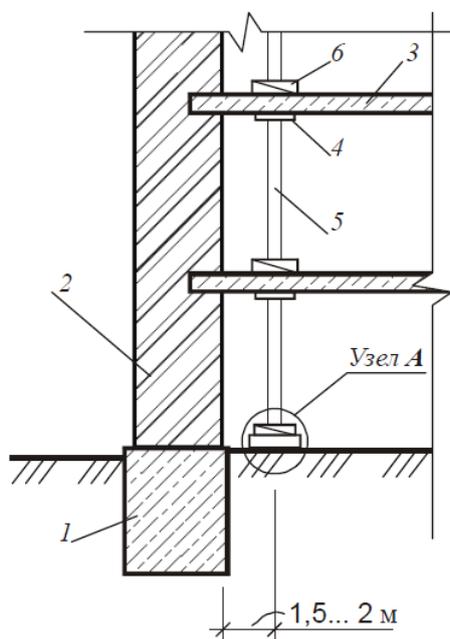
Частичная разгрузка фундаментов с применением временных деревянных опор: 1- фундамент; 2-стена; 3 -перекрытие; 4-верхний прогон; 5-стойка; 6-клинья; 7 – опорный брус; 8 – опорная подушка
